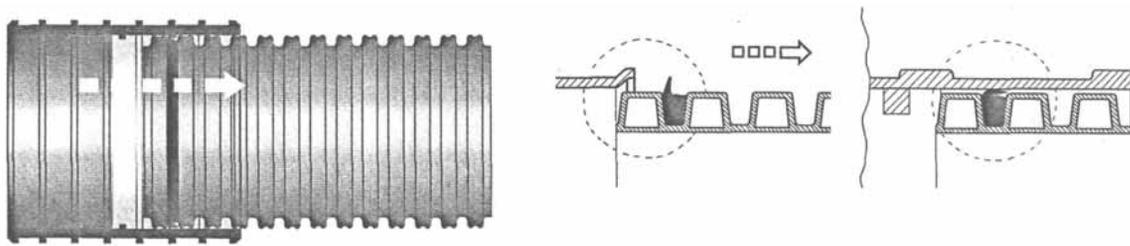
Соединение труб КОРСИС с помощью муфты и уплотнительного кольца
